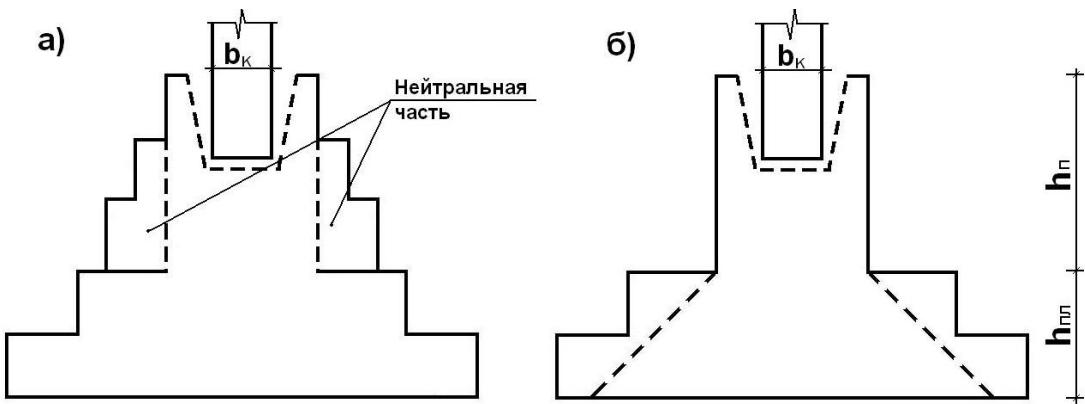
Схема конструкування фундаменту з підвищеною стаканною частиною: а) масивний фундамент; б) фундамент з підколонником.
